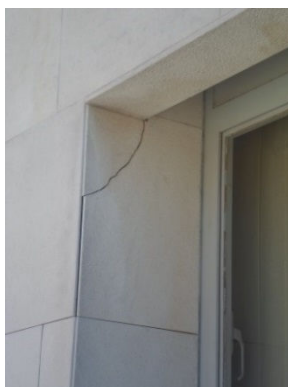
Fissuras no revestimento em placas de pedra colada
